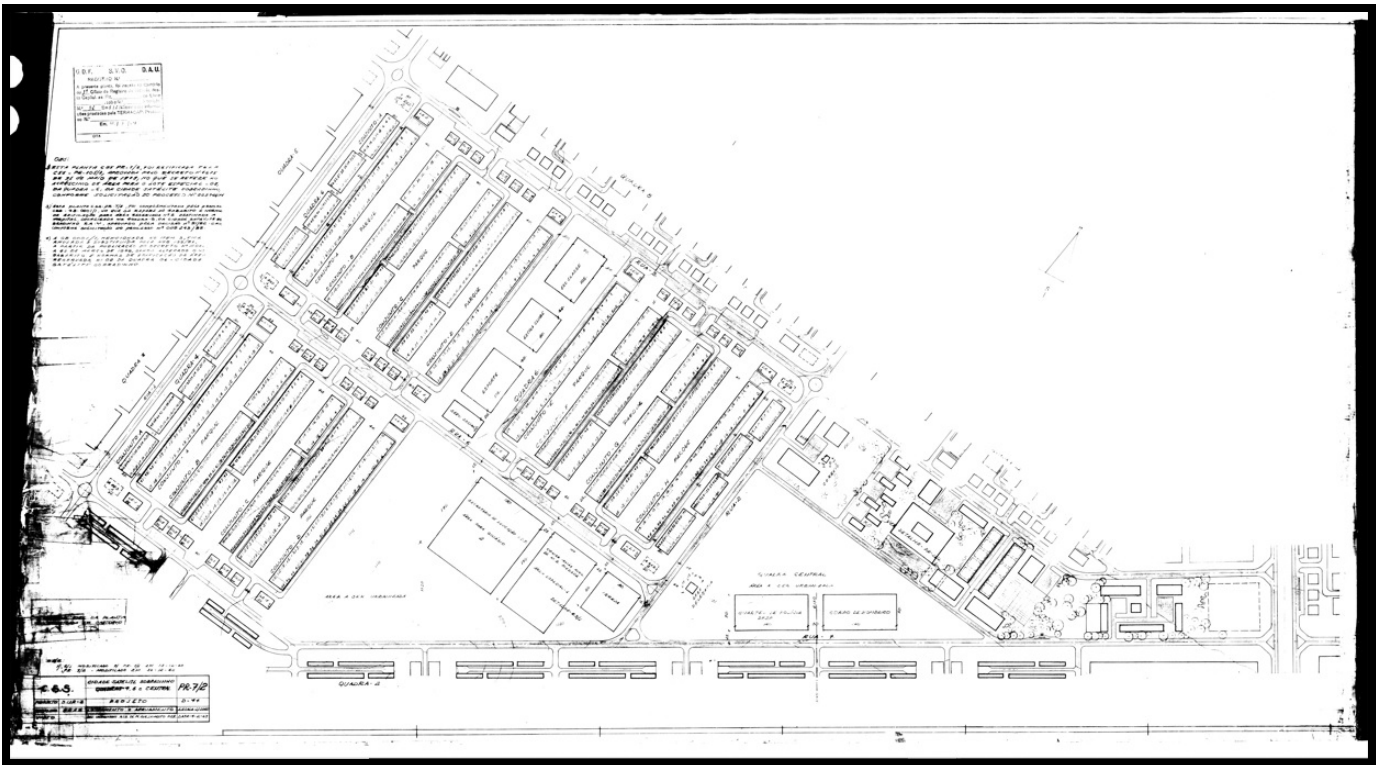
Planta Registrada CSS PR 7/2. Fonte: Mapoteca/Seduh.
